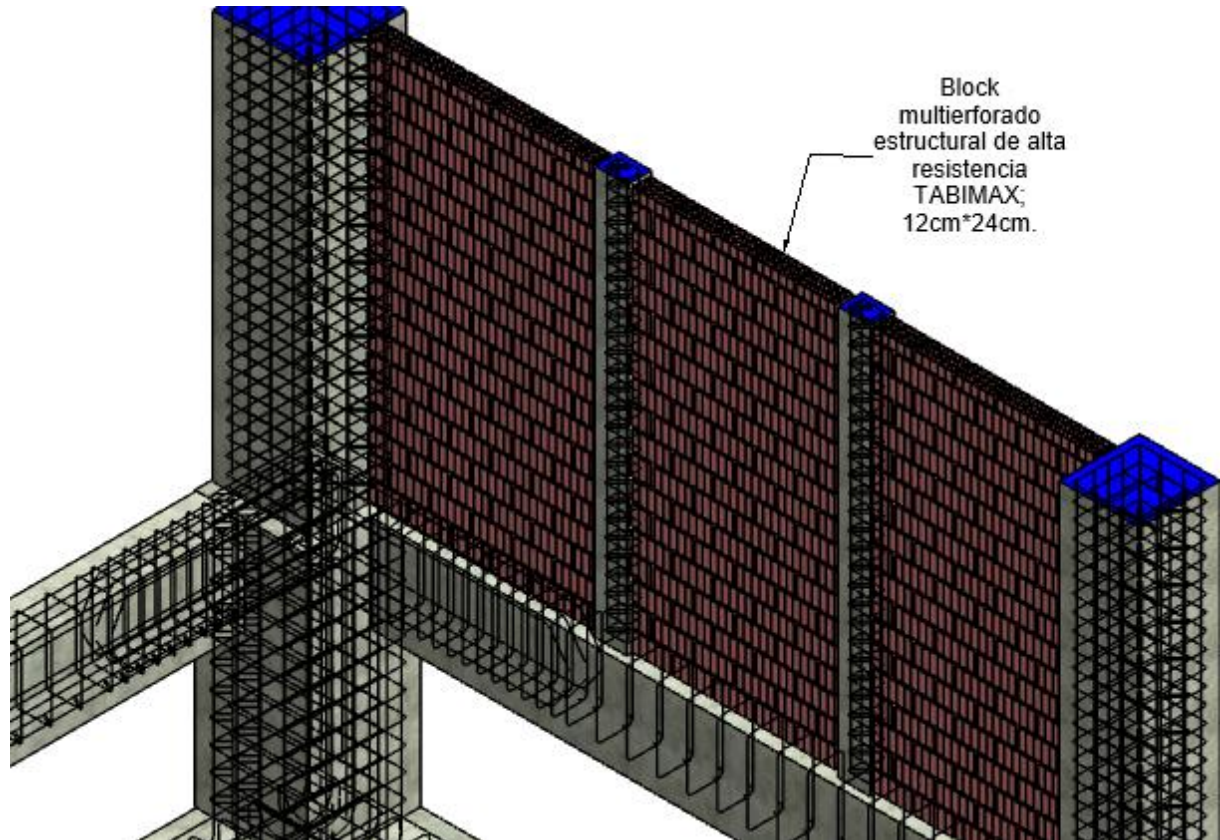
LOD 350 de Muros mampostería en Torre 1 (Autoría propia).
